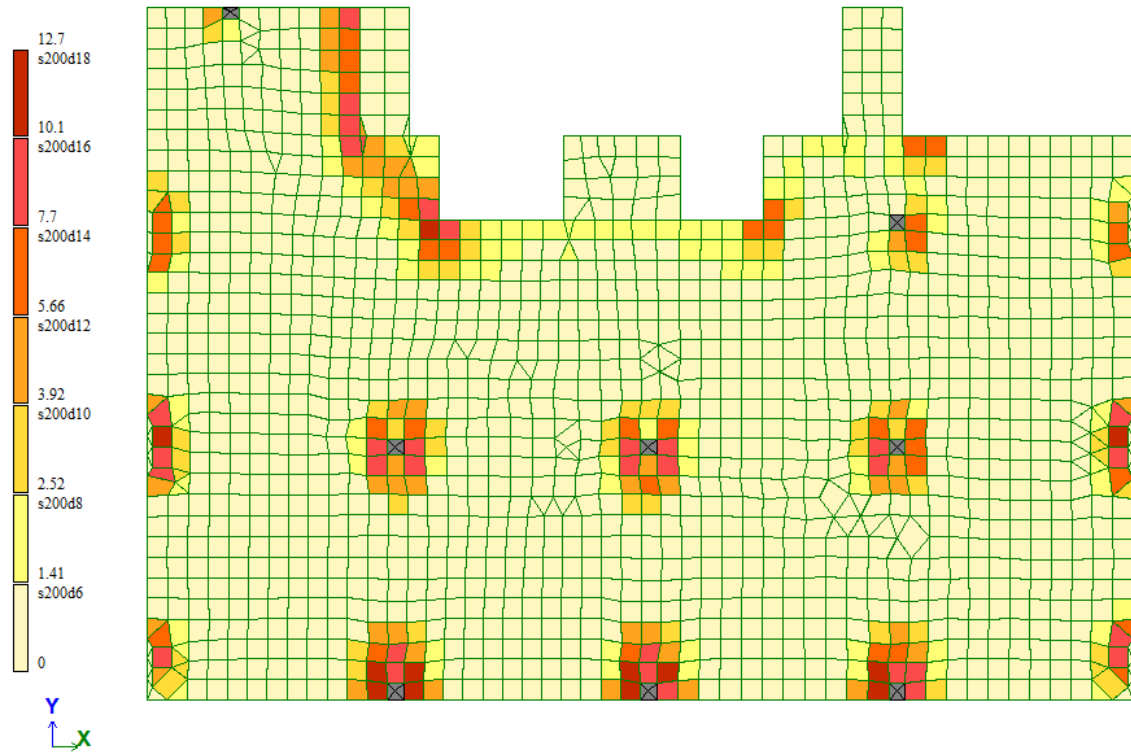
Арматування плити перекриття по нижній грані вздовж осі X, см<sup>2</sup>
